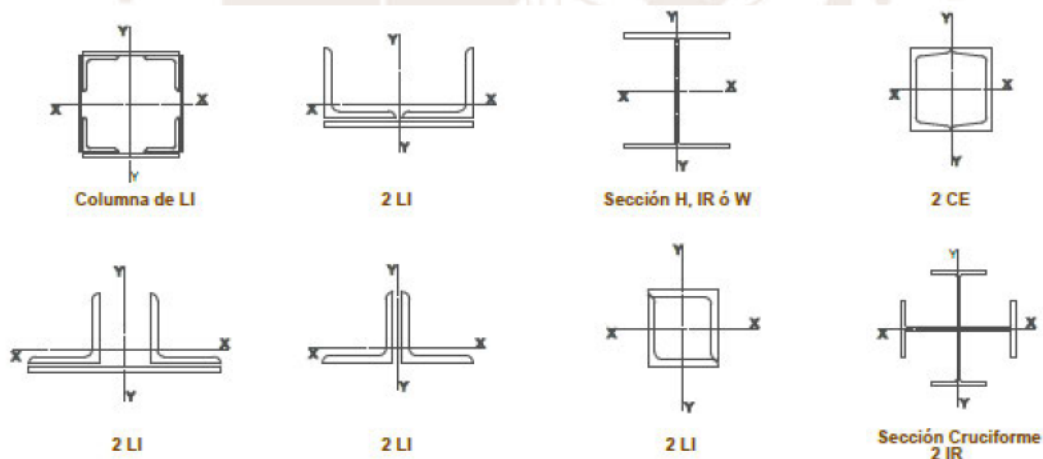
Secciones transversales típicas de miembros en compresión axial
